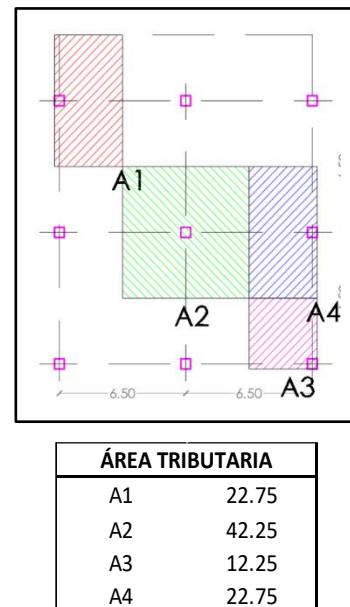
Pre-dimensionamiento de columnas Bloque II y Bloque III
